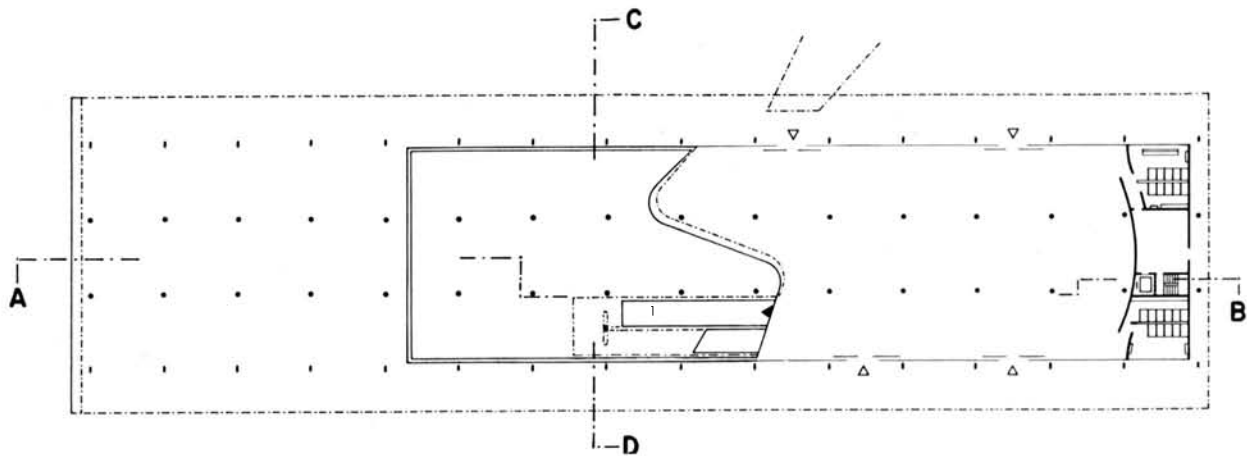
PALÁCIO DOS ESTADOS - TÉRREO - PLANTA BAIXA
